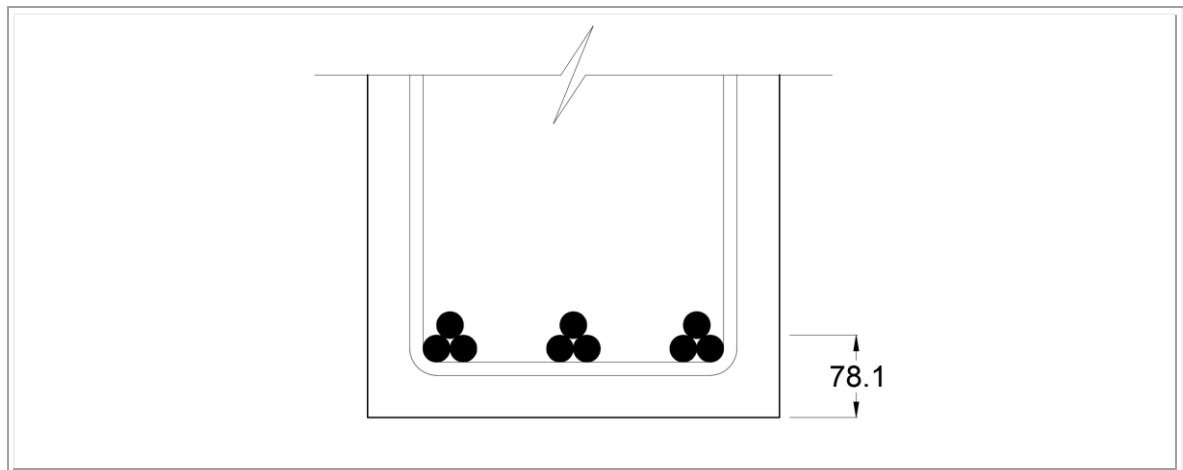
Centroides del refuerzo en el apoyo para 9 barras
